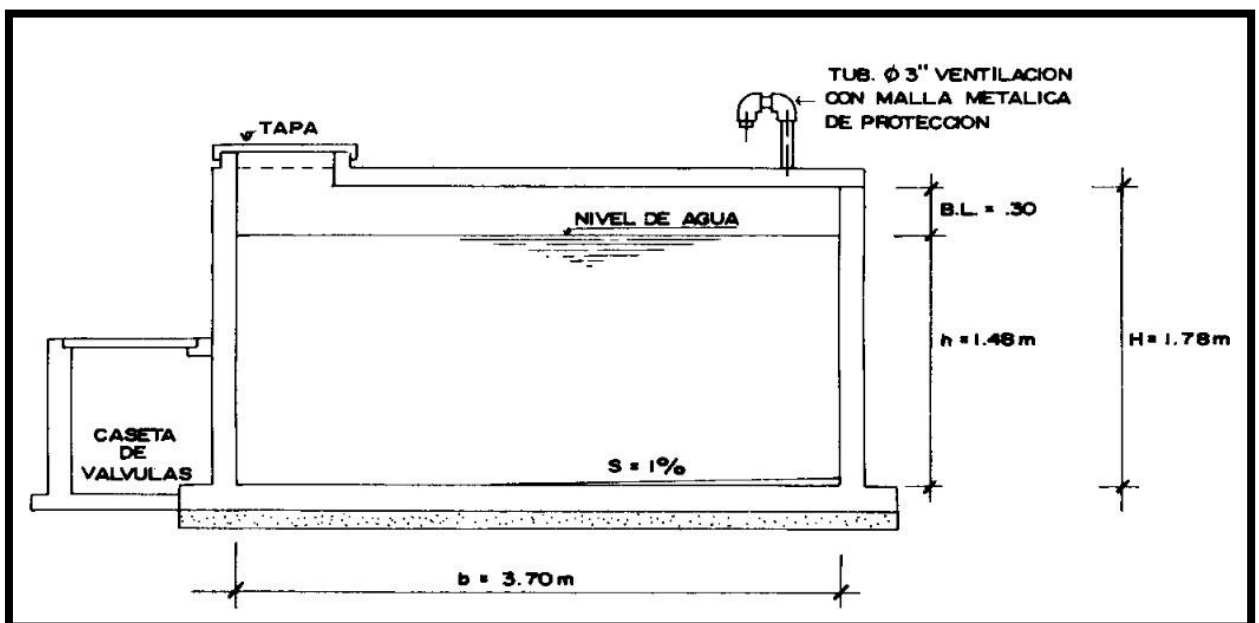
Reservoirio Rectangular Apoyado - Vista en Elevación
